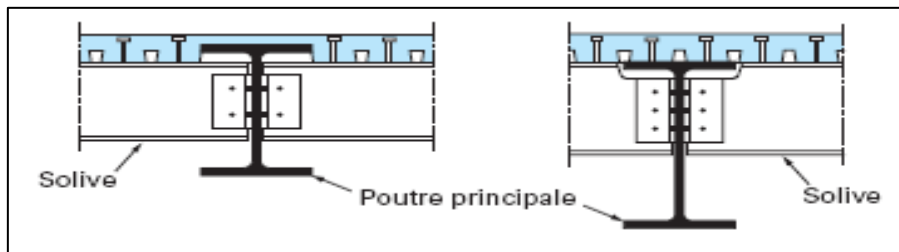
Assemblage par gousset d'âme et plaque de contact
